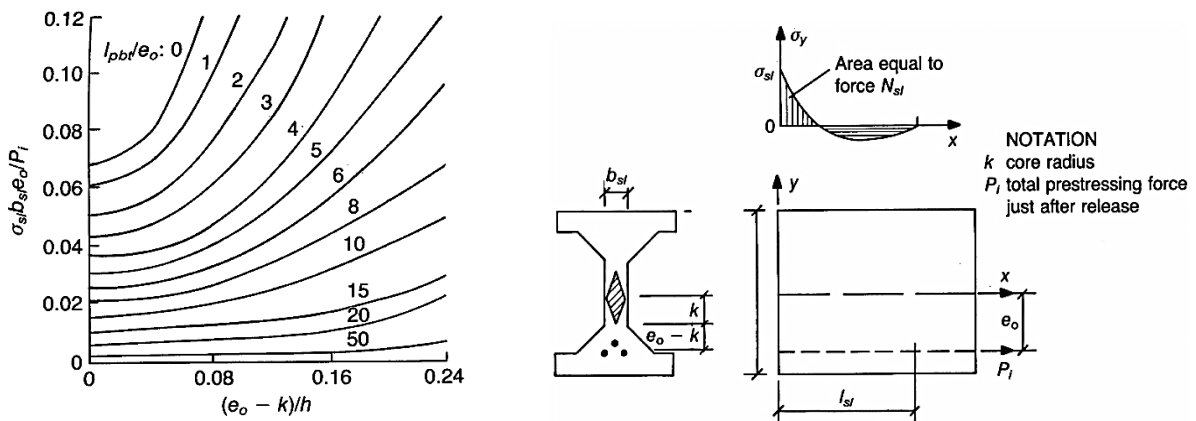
Máxima tensão de *spalling* para secções vazadas [17]
